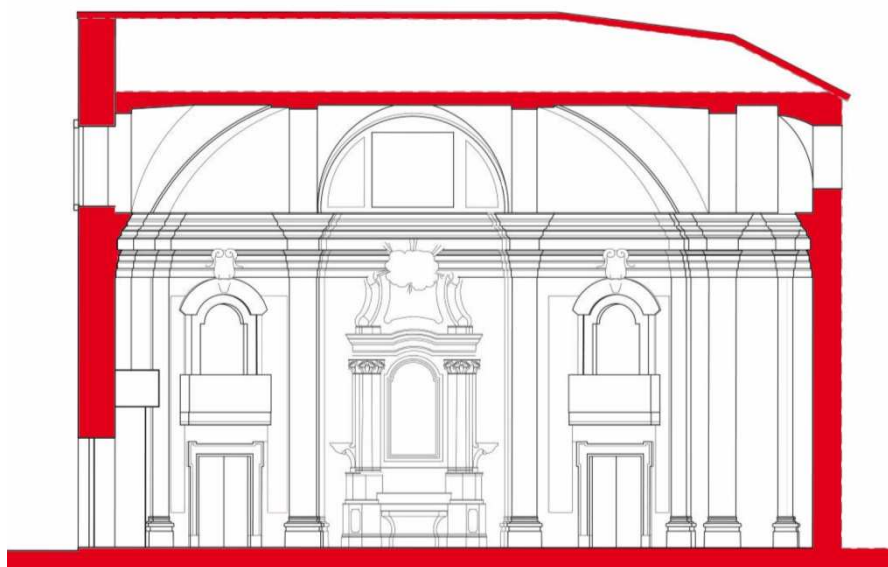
Sezione longitudinale verso la chiesa di san Biagio.
